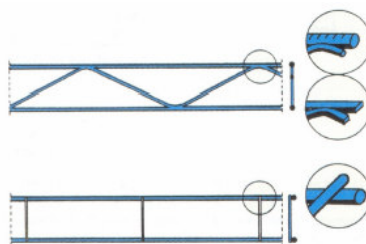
Exemplos de diferentes tipos de armaduras para paredes de alvenaria
